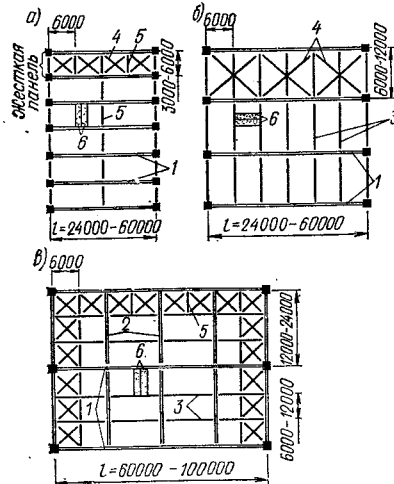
Конструктивные схемы (а-в) стропильных покрытий
